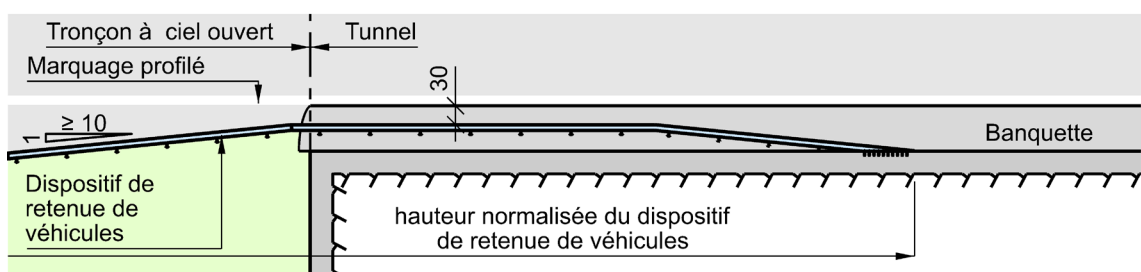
Variante 2c – La glissière de sécurité est placée à l'intérieur du tunnel, fixée directement au portail du tunnel
